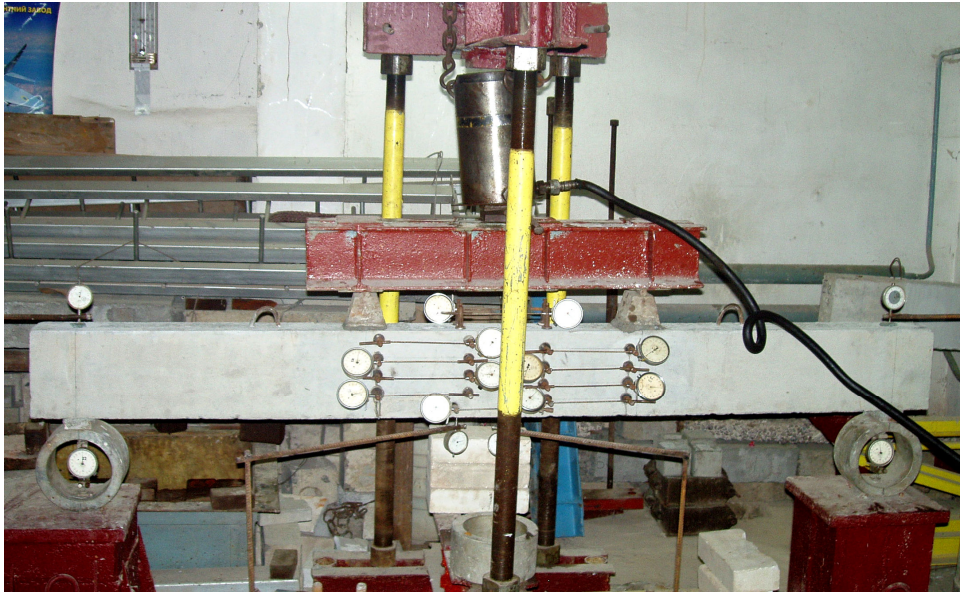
Загальний вигляд підготовленого до випробовування зразка
